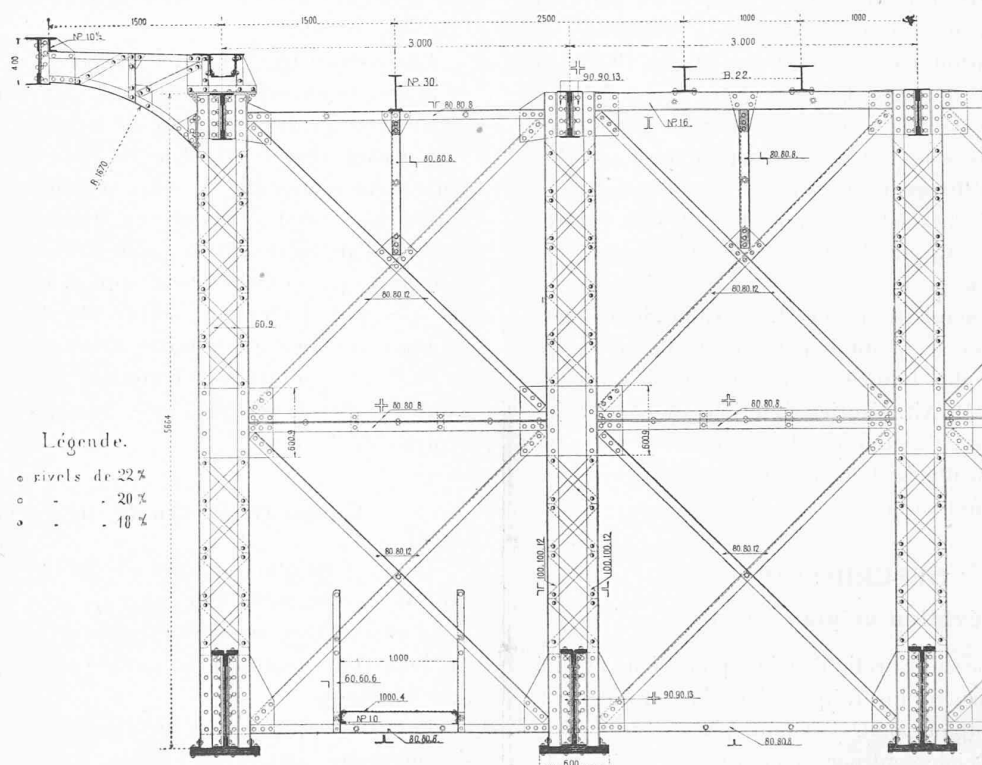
Demi-coupe transversale au montant 2-3. — Echelle 1 : 60.
